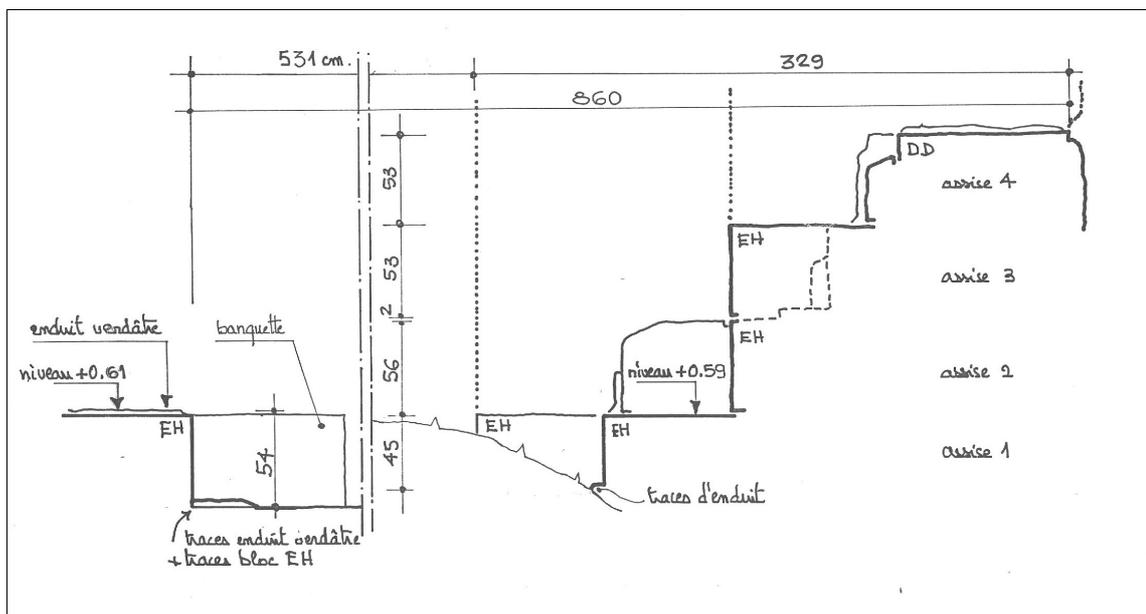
Relevés en secteur 1 : coupe A, sur le sondage n°2.
